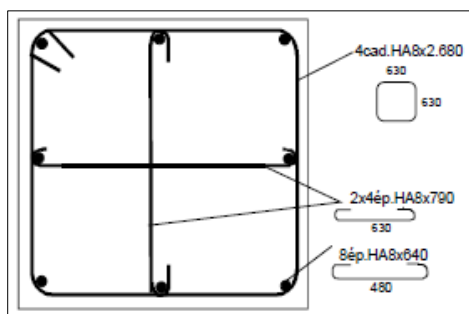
Ferrailage de l'exemple proposé par M. Thonier
